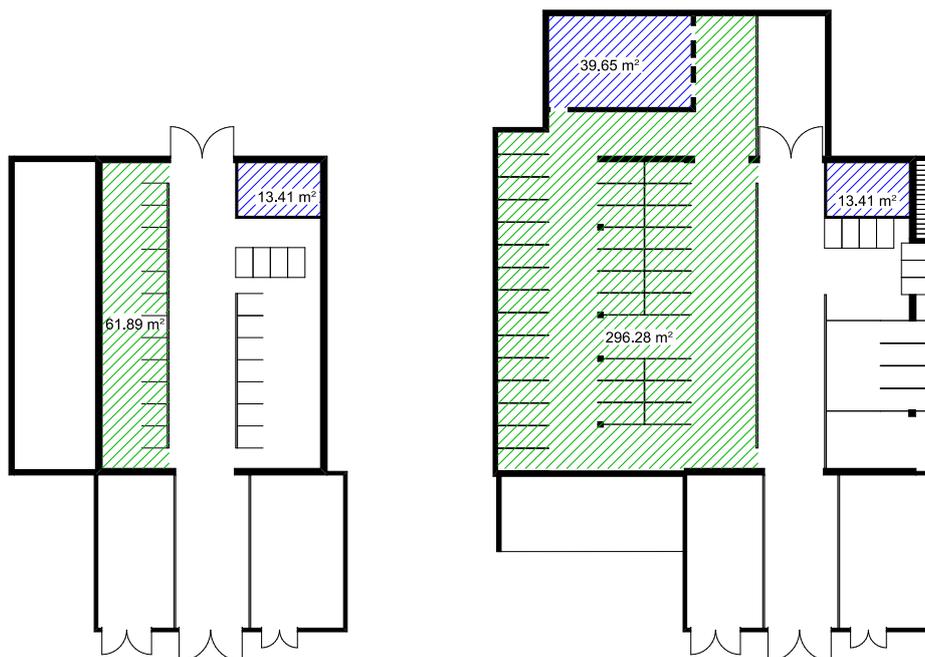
Netto-Grundflächen Betrieb A vor (links) und nach (rechts) dem Umbau, blau schraffiert = Milchkammer/Technik/Nebenräume und Melken, grün schraffiert = Stallbereich Milchkühe
